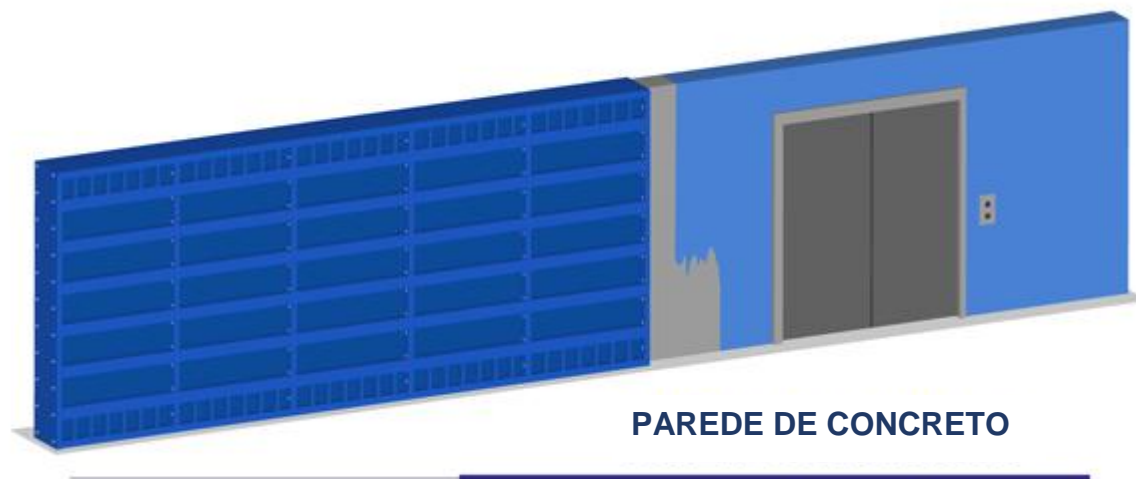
Sistema Construtivo: Parede de Concreto (Fonte: Astra S.A, 2016)
